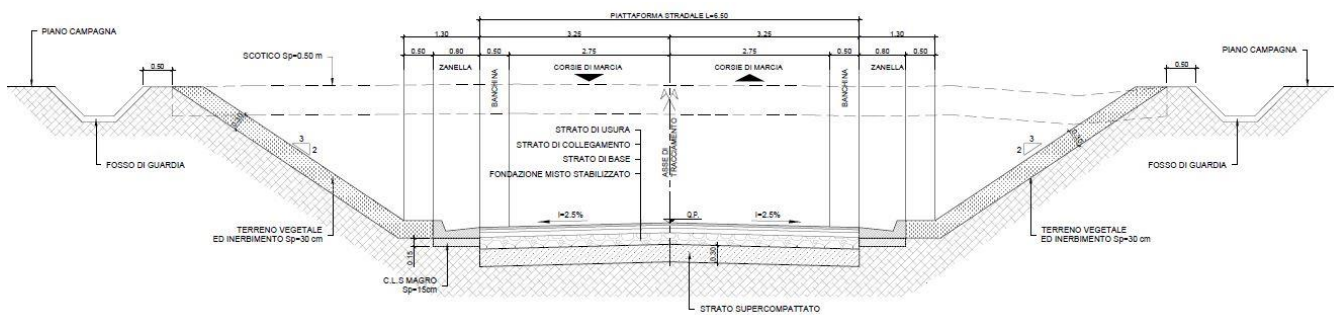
Dest. Particolare 6.5m - sezione tipo in trincea
